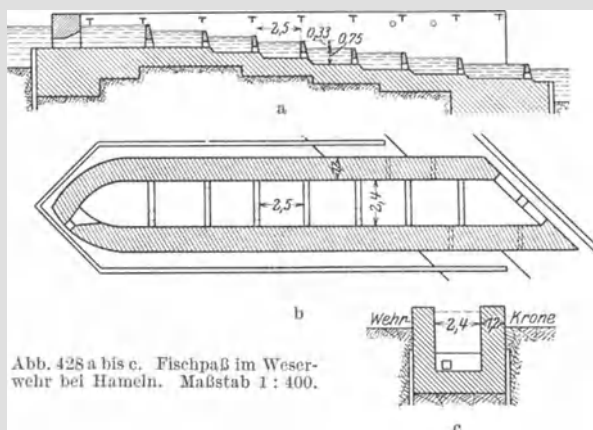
a bis c. Fischpaß im Weserwehr bei Hameln. Maßstab 1 : 400.
